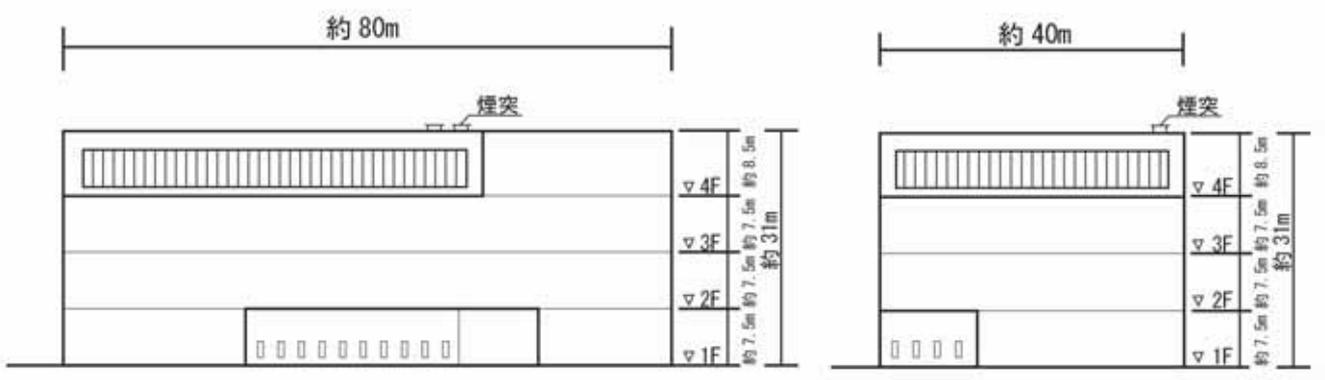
(2) エネルギー施設 B の平面図及び断面図
